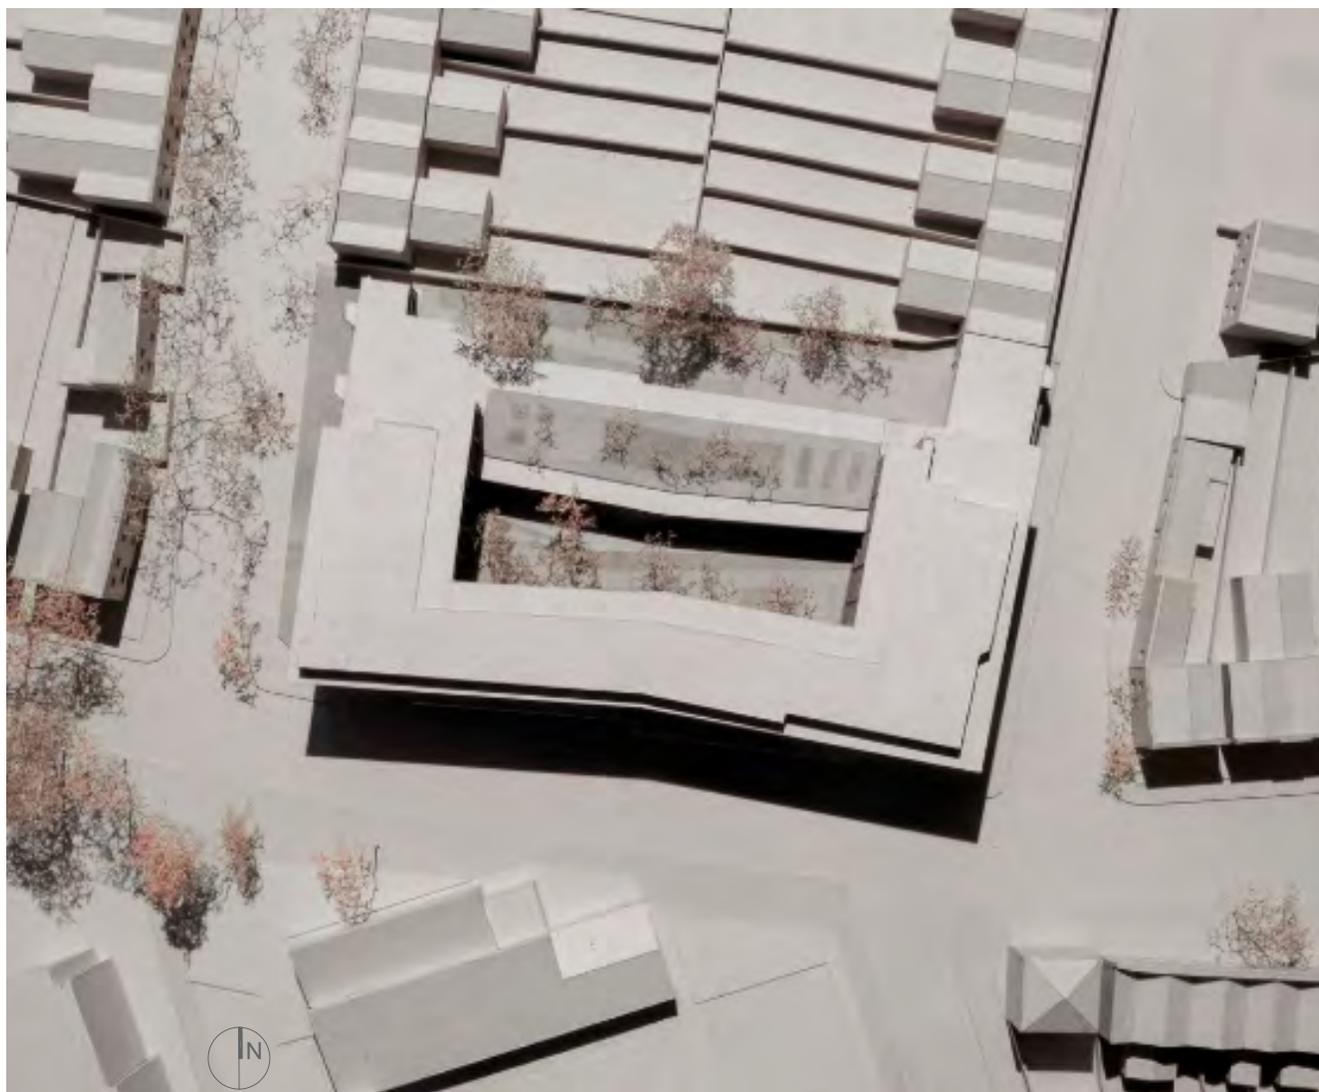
Maqueta de conjunto, Alms House. Vista aérea del conjunto.
